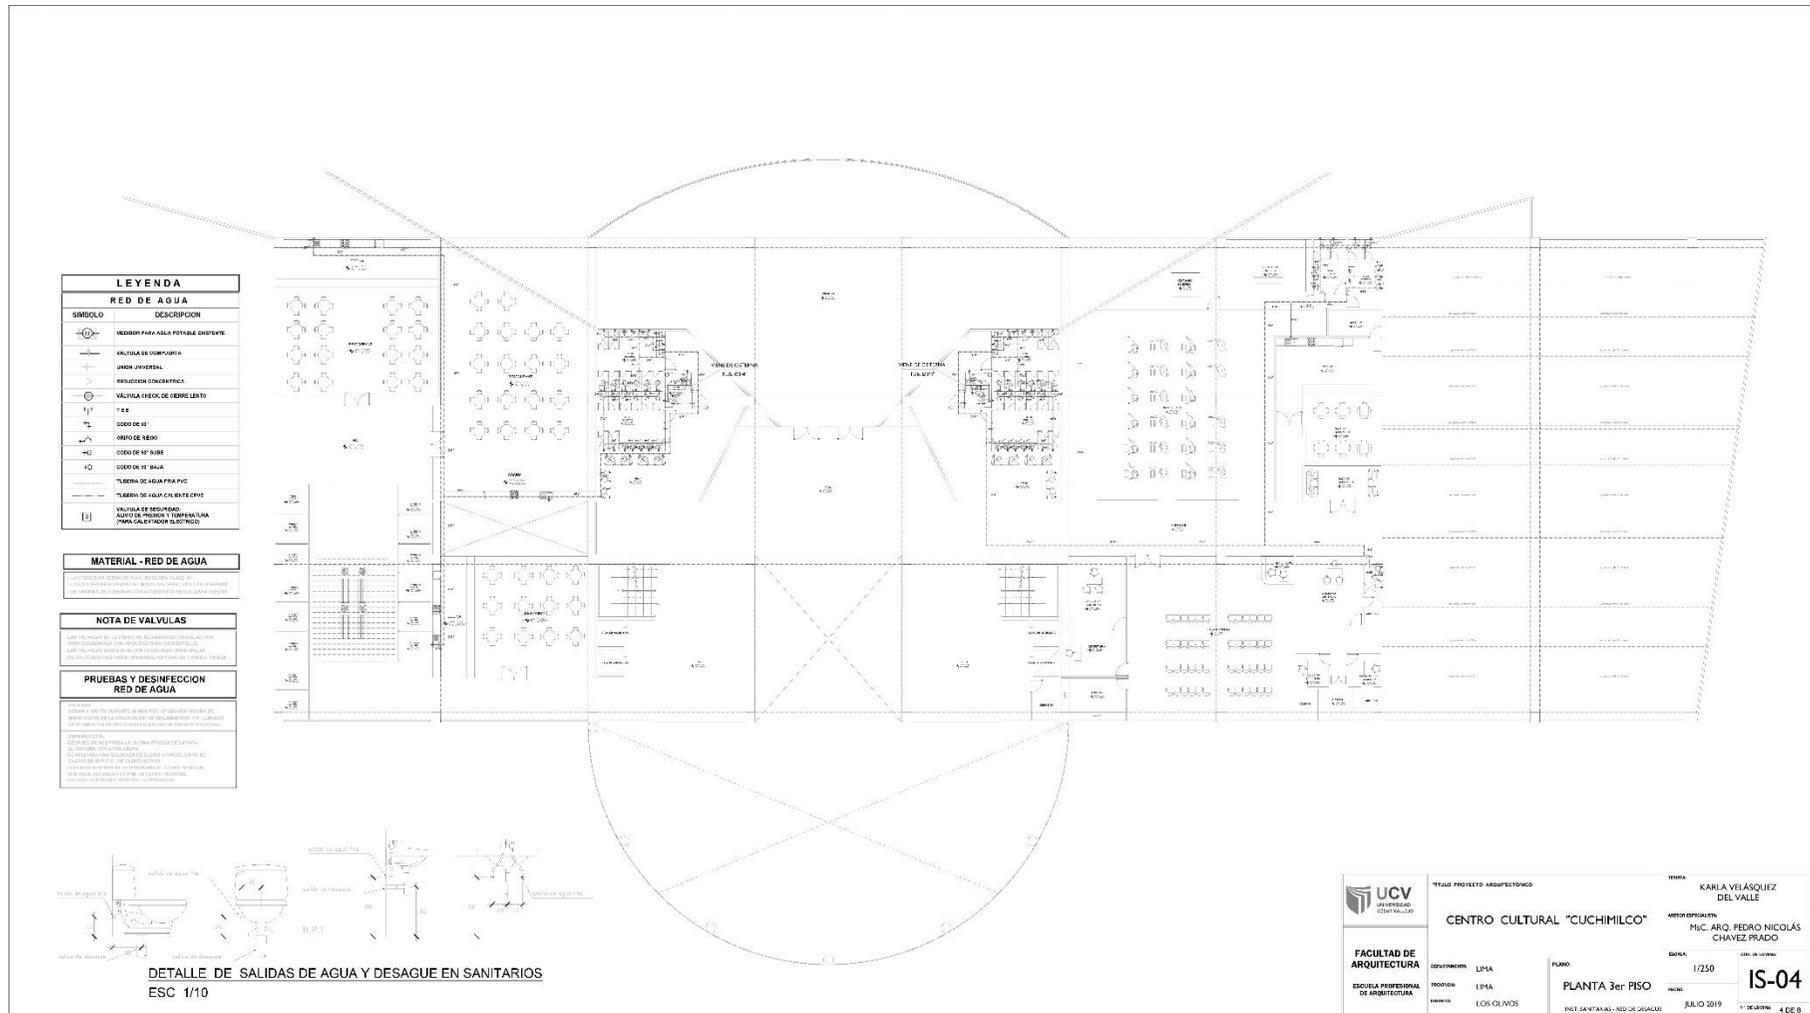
Plano de Agua Planta 3er Piso. Elaboración propia
